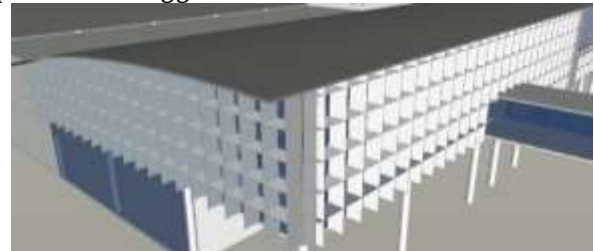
Detil ruang domestik (kiri) dan ruang internasional (kanan) metode sirip horizontal
